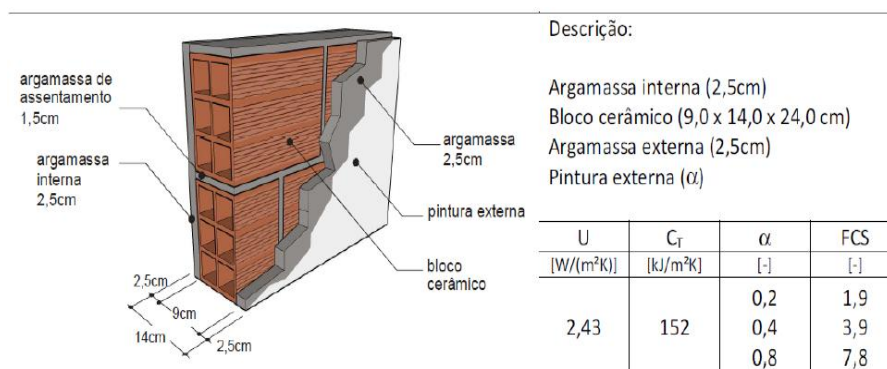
Configuração das paredes externas. Fonte: LabEEE, 2011
